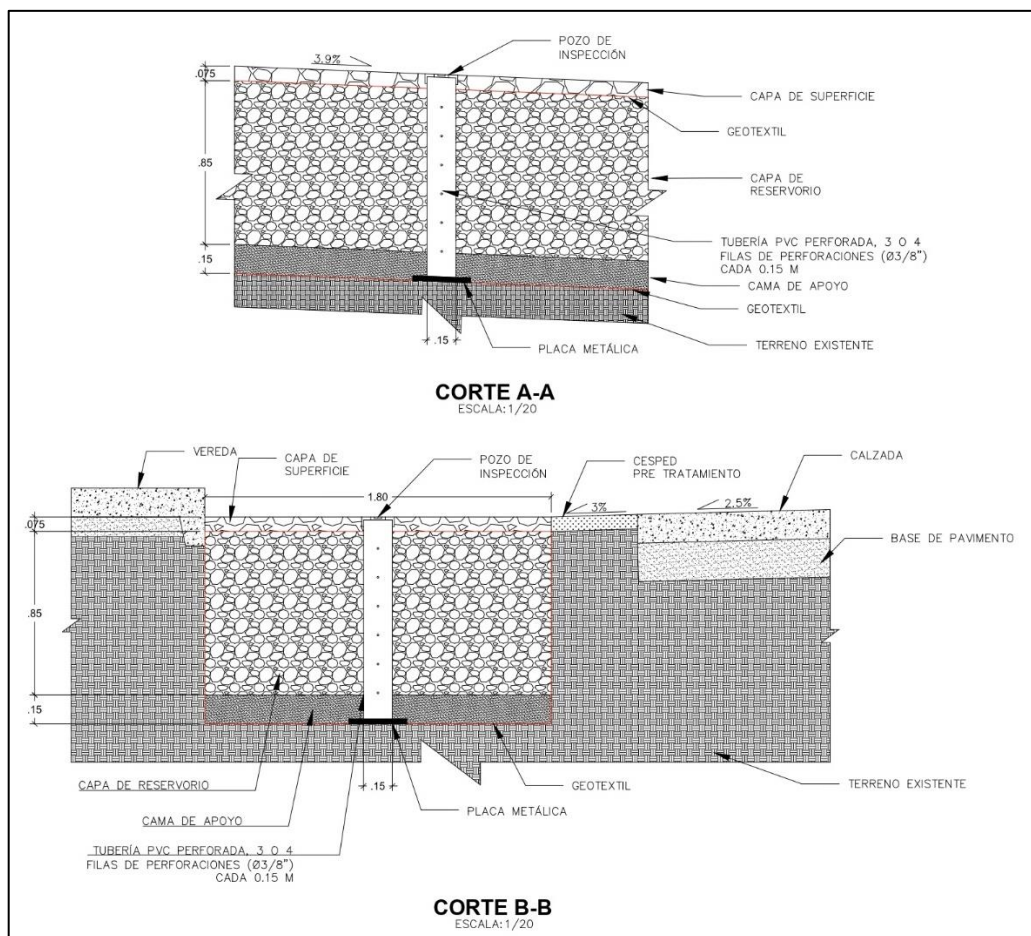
Secciones de la zanja de infiltración (IFT04)
